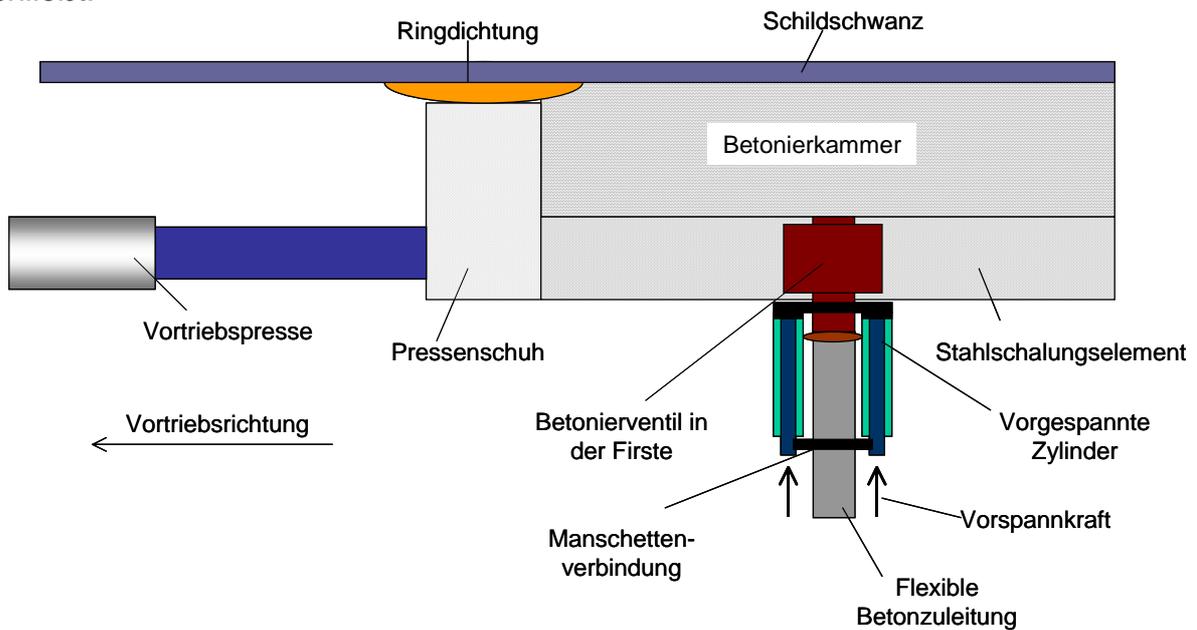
Schema Überdruckventil inaktiver Zustand
